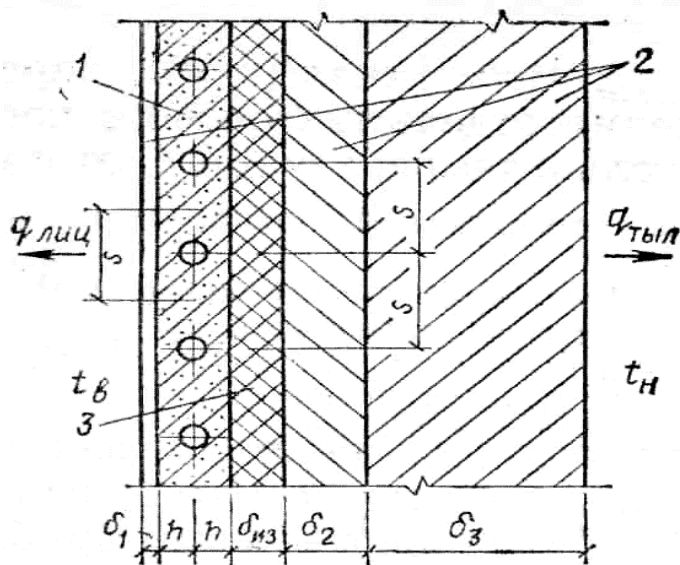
Разрез наружного ограждения с совмещенной бетонной отопительной панелью;
